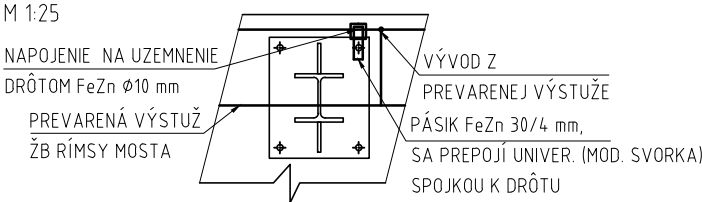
DETAIL ÚPRAVY POZDĽ. ŠKÁRY
